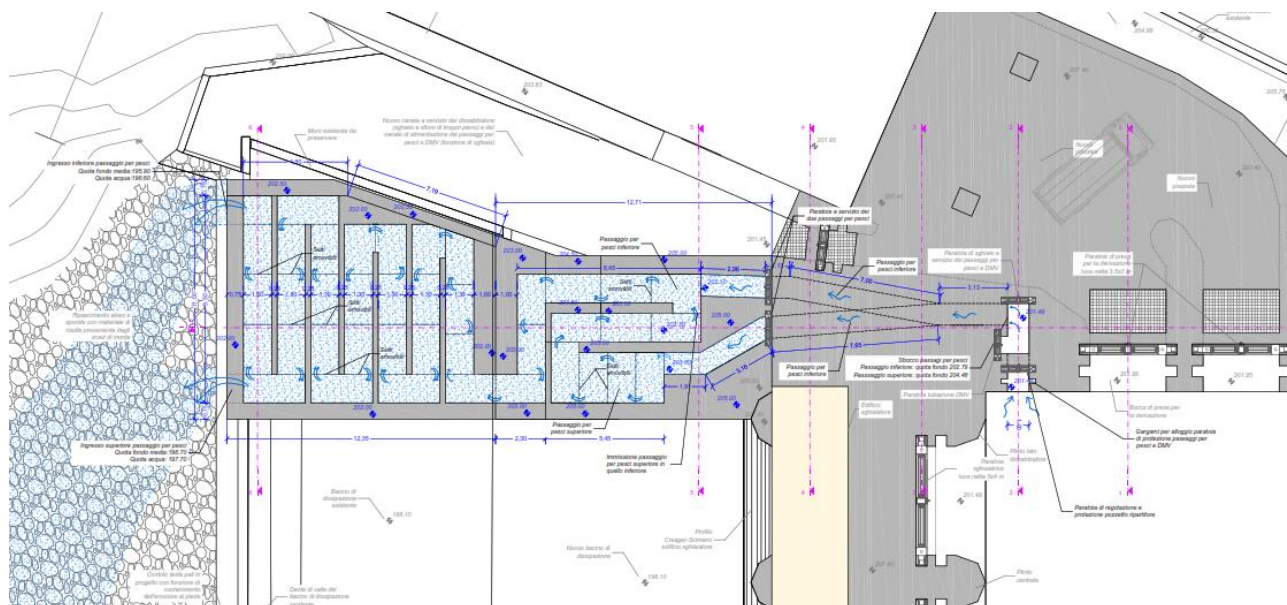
immagine estratta da planimetria di progetto 3.1.6
